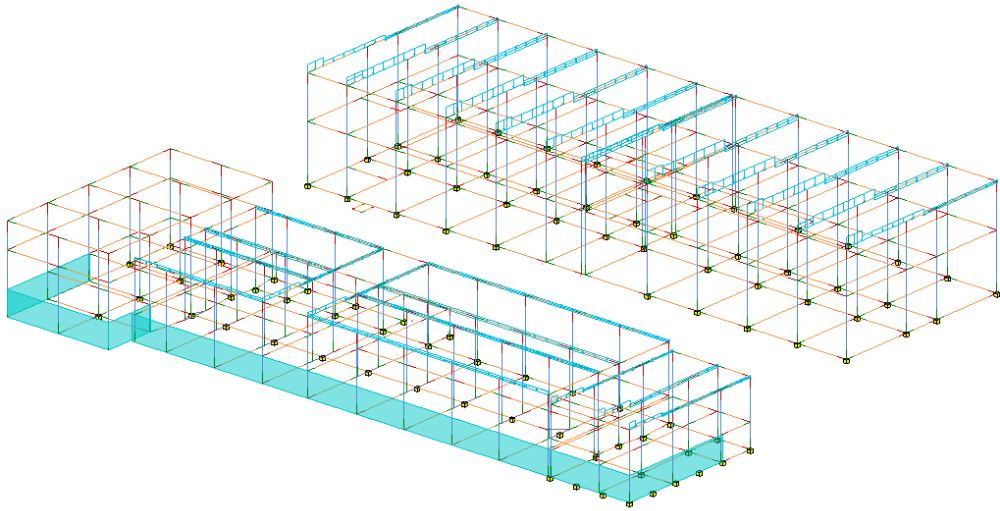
Vista 3D del modelo analítico con las cargas de viento norte sobre cubierta
